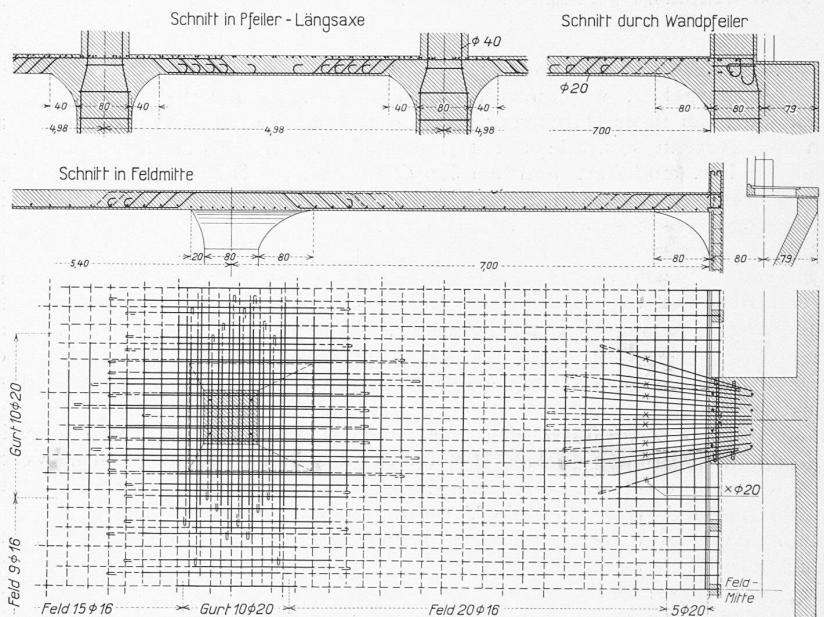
Armierung einer Pilldecke für 750 kg/cm² Nutzlast. — Masstab 1 : 100. Volle Linien obenliegende Eisen, gestrichelt untenliegende Eisen.
